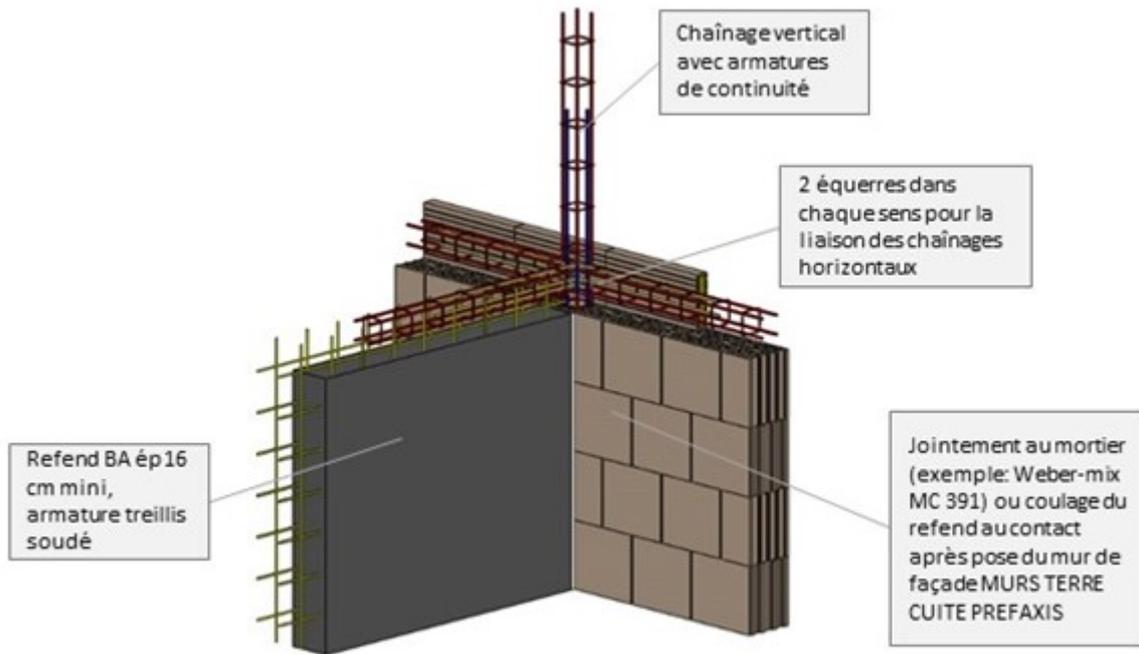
Détail jonction refend MUR TERRE CUITE PREFAXIS façade (locaux non chauffés ou ITE)
